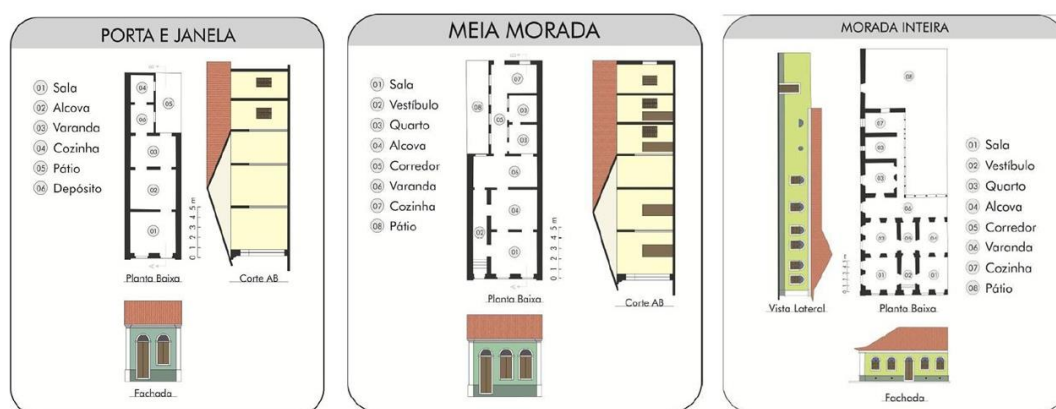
Desenhos esquemáticos (planta baixa, fachadas e Cortes) de moradas térreas. Fonte: Figueiredo, 2014: 52-54, adaptado de Silva Filho, 1998 (1986).
